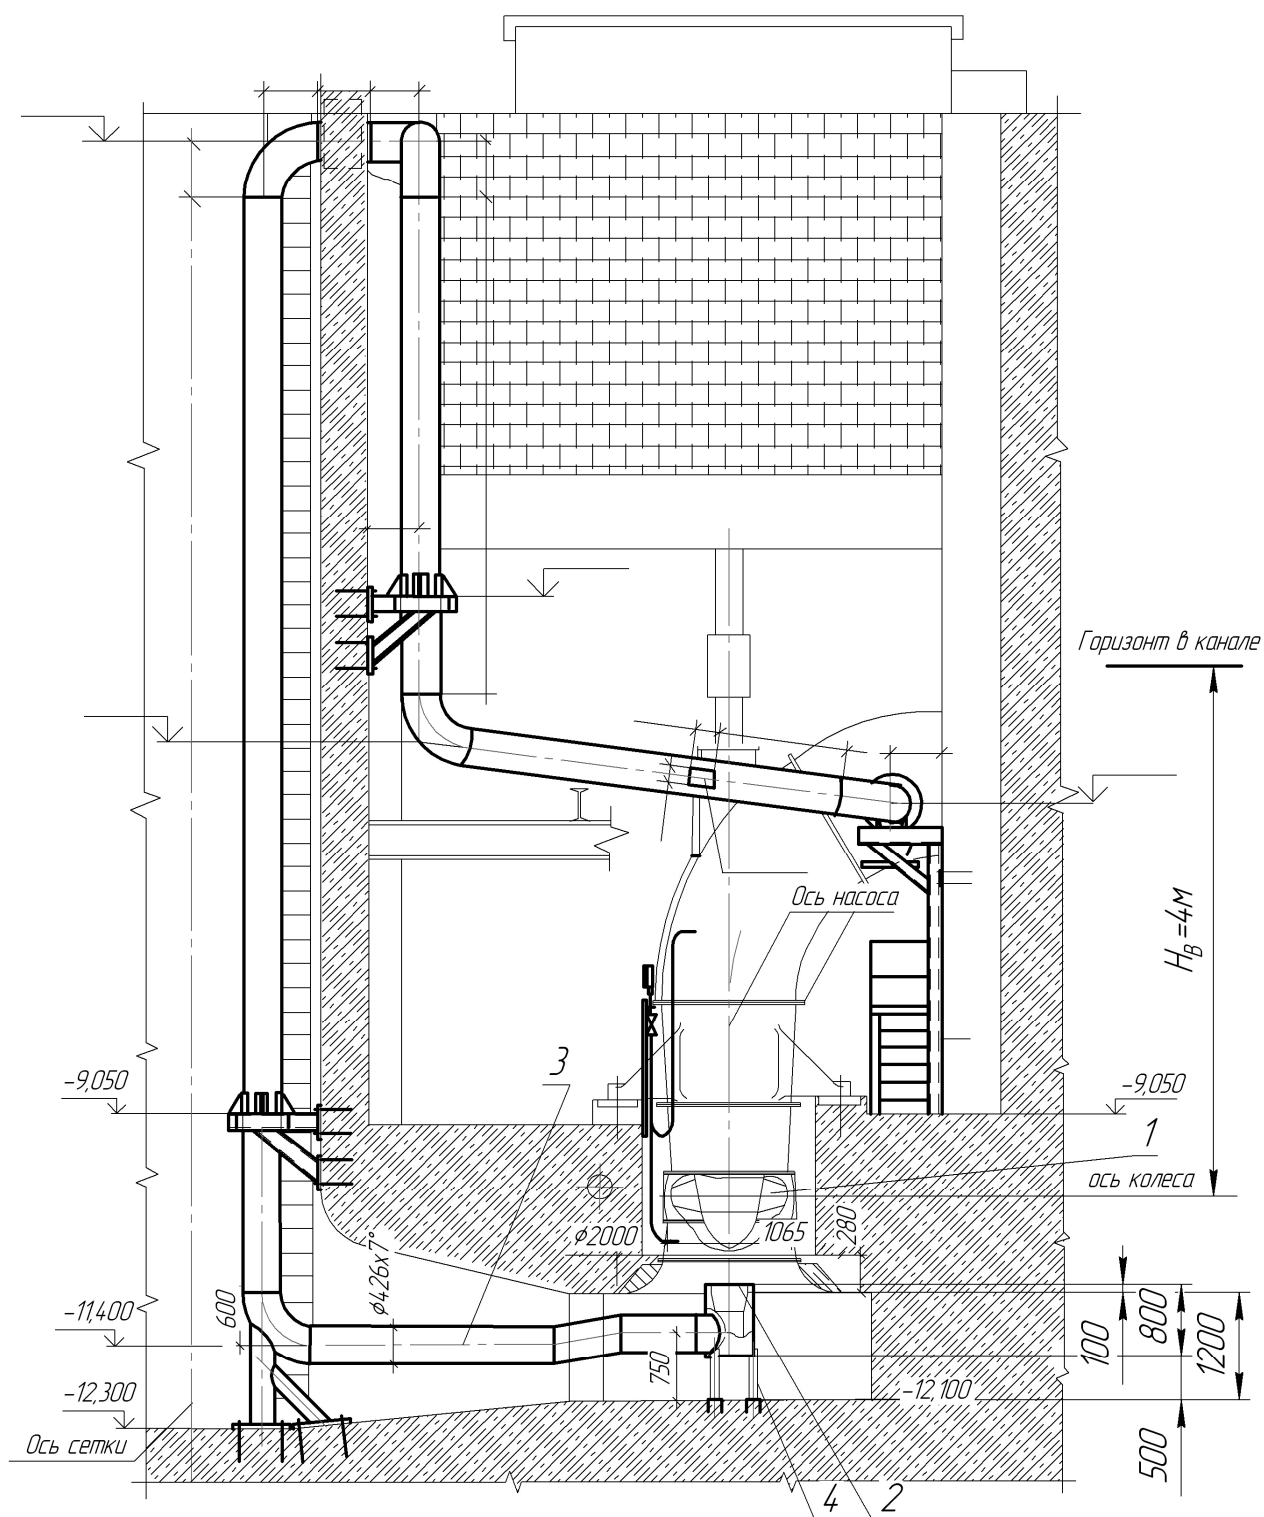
Размеры и место установки кольцевого двухповерхностного струйного насоса:
